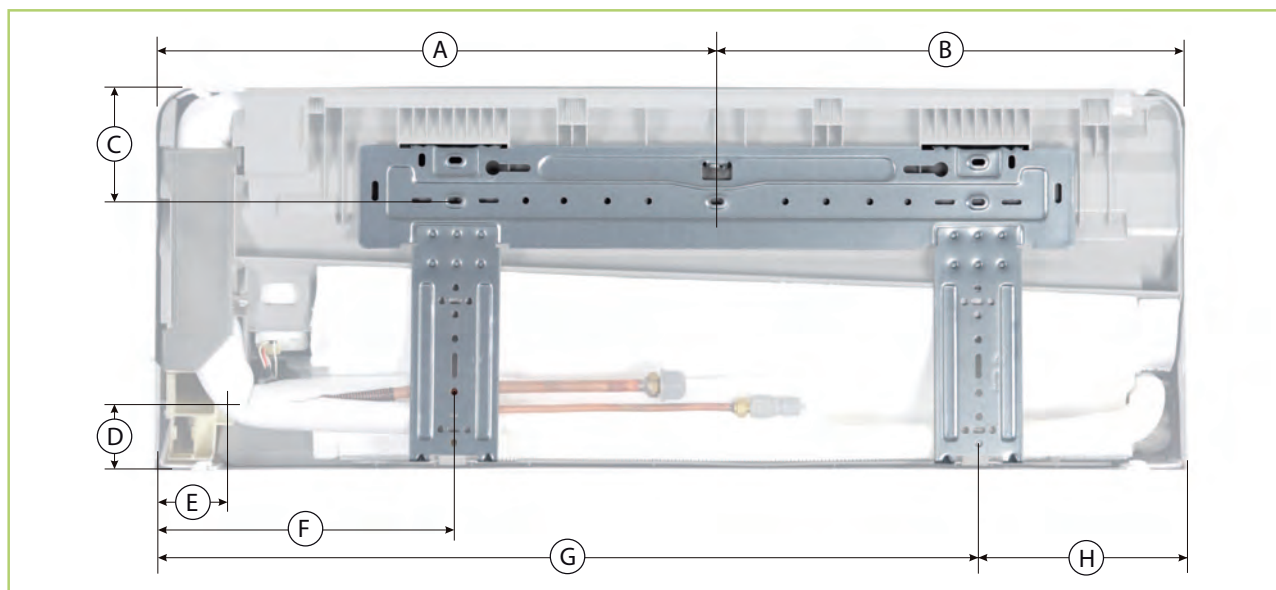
Montagepunkte der Wandhalterung JBW 260 DC-520 DC (Rückansicht)
